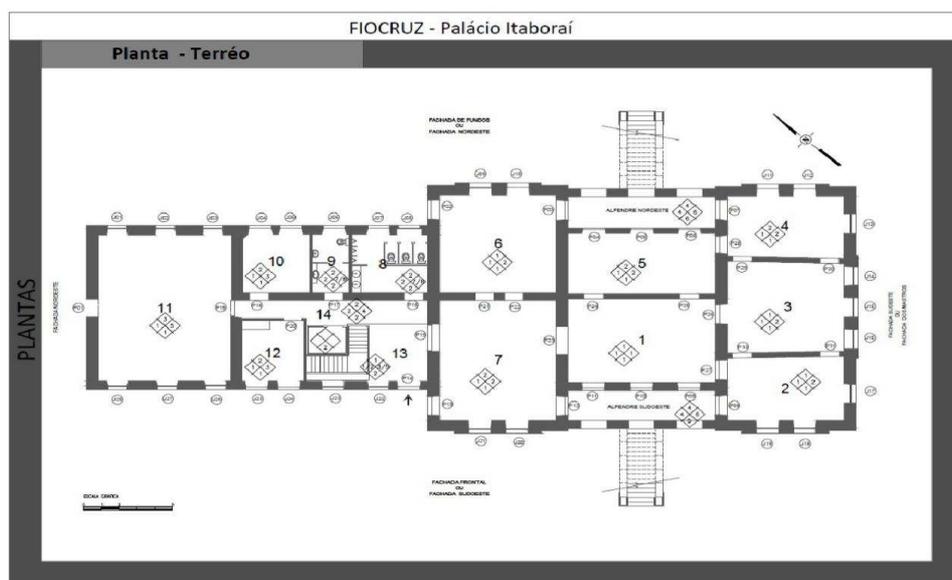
Anexo III Plantas – Planta do Térreo. Fonte: Plano de Conservação do Palácio Itaboraí, 2013.
